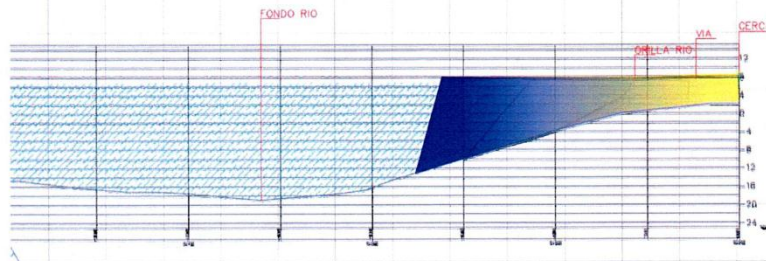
perfil longitudinal del espigón de acuerdo a Batimetría.
